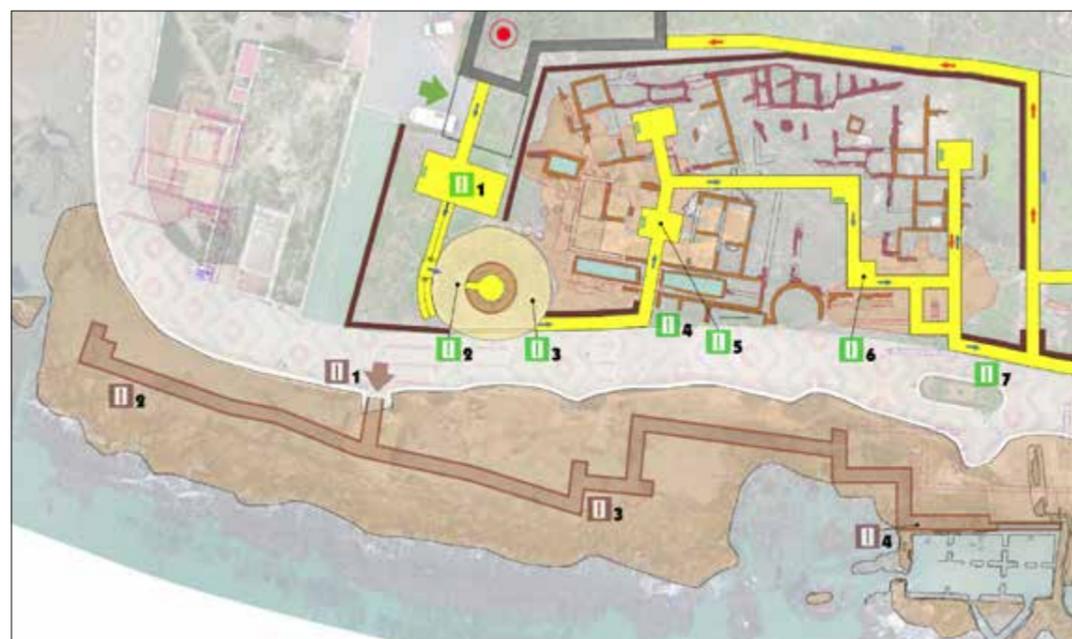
Etapa Segunda. Fase "F". Pasarelas de madera sobre las canteras al Poniente de "Los Viveros". Propuesta. Detalle del plano P-02.6
